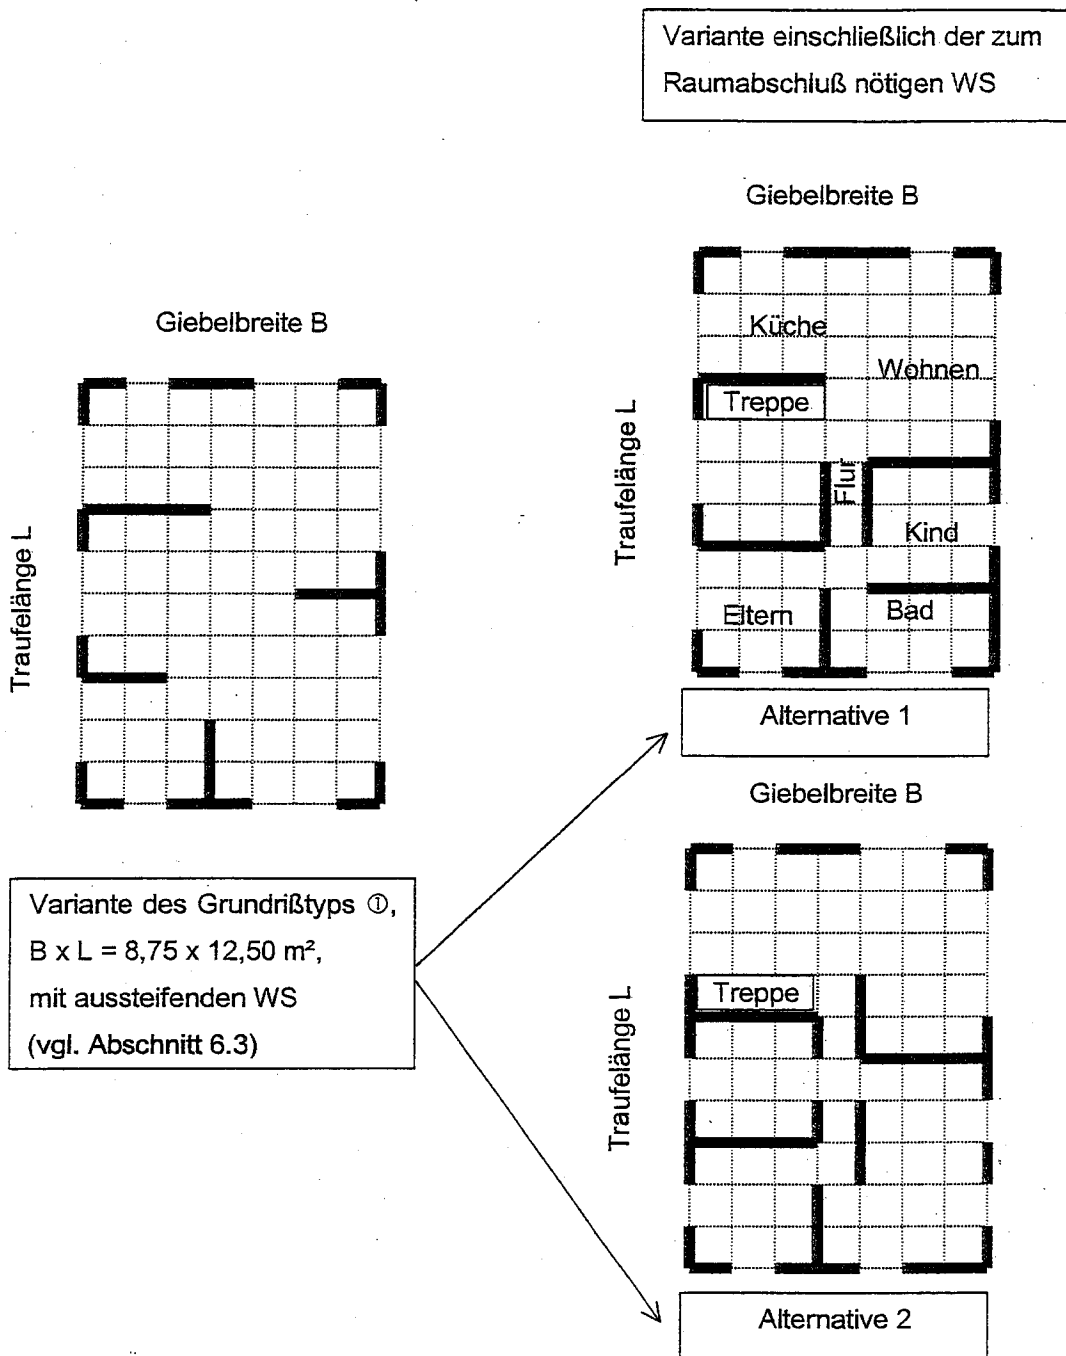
Grundrißvariante und Alternativen 1 und 2 mit den zum Raumabschluß erforderlichen Wandscheiben
